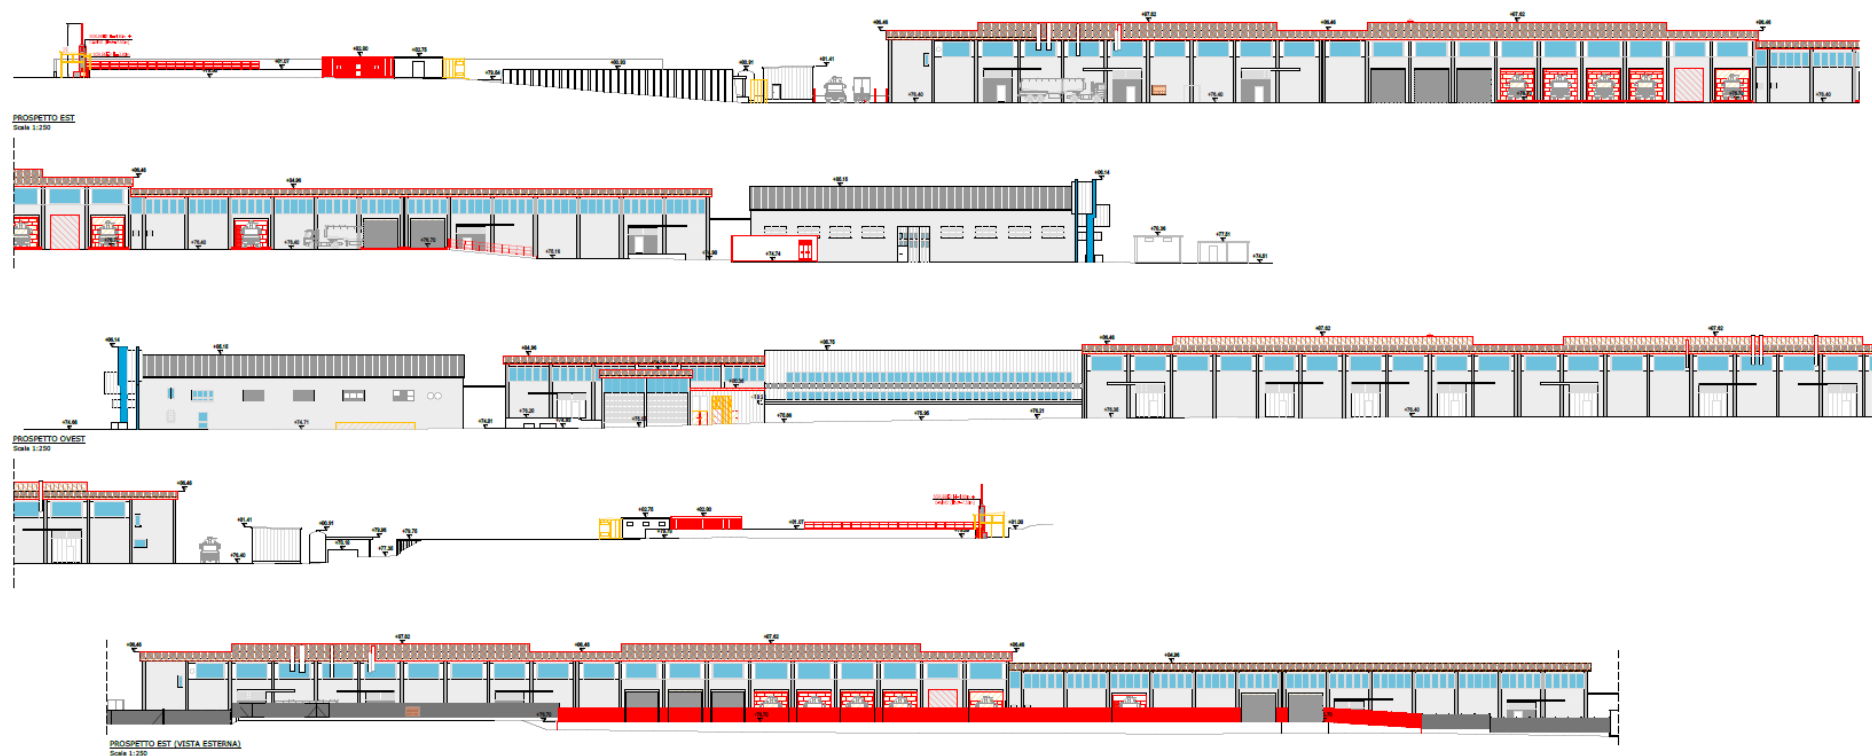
Prospetto Est e prospetto Ovest del sito di intervento nello stato comparato, in rosso le costruzioni e in arancione le demolizioni [Fonte: stralcio Elaborato PD B.13]
